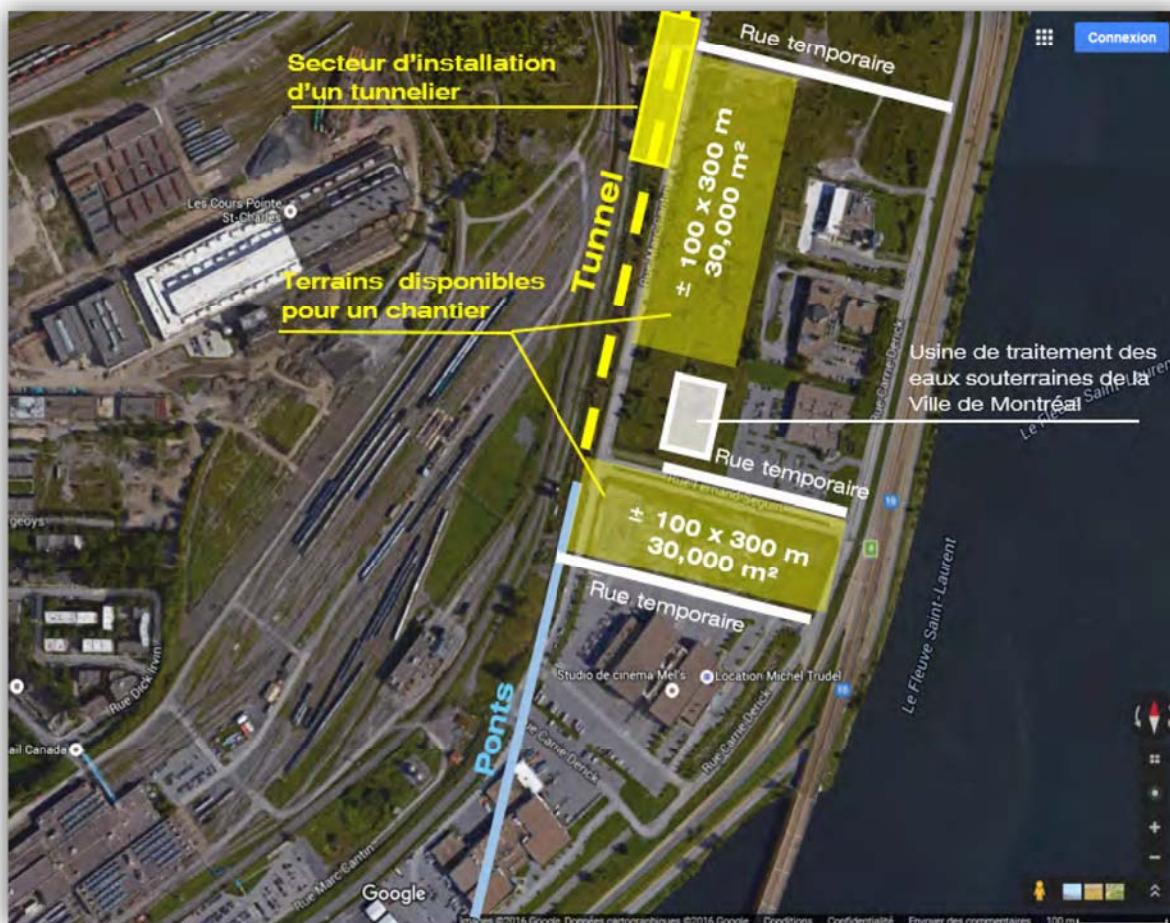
Site d'installation d'un tunnelier et terrains disponibles pour un chantier
